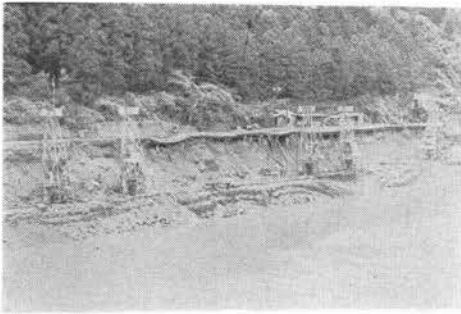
天竜水窪線道路災害復旧工事の機械配置状況
